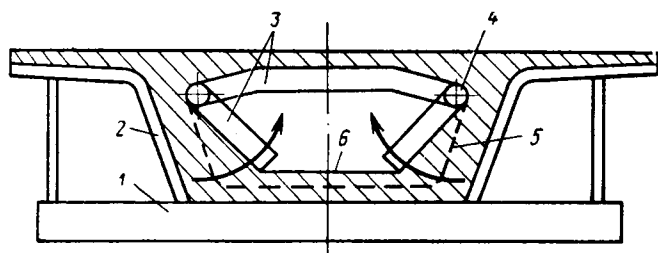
Схема трансформирования оснастки для изготовления блоков с утолщенной нижней плитой и стенками: 1 — поддон; 2 — внешняя опалубка; 3 — элементы внутренней опалубки; 4 — шарнирное соединение элементов внутренней опалубки; 5 — контур рядового блока; 6 — контур блока с утолщенной нижней плитой и стенками
